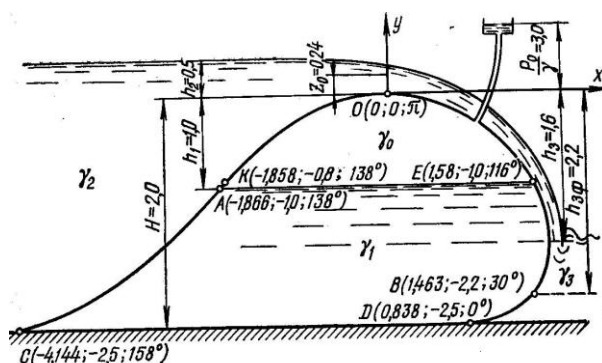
Схема к примеру расчета мягкой наполняемой плотины.
